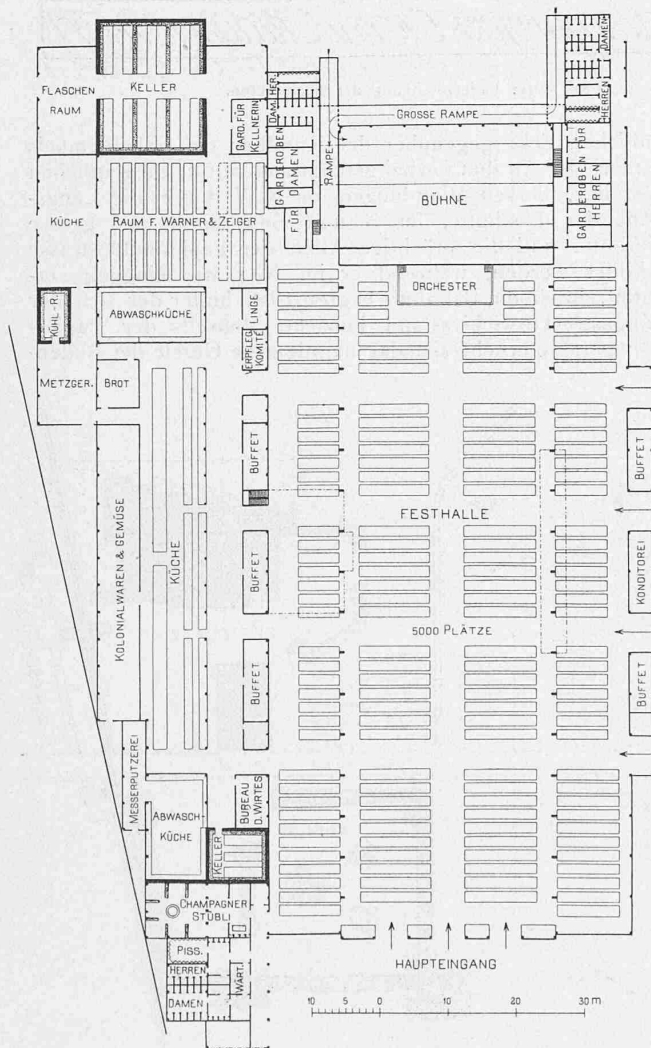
Grundriss der Festhütte. — Masstab 1 : 1000.
